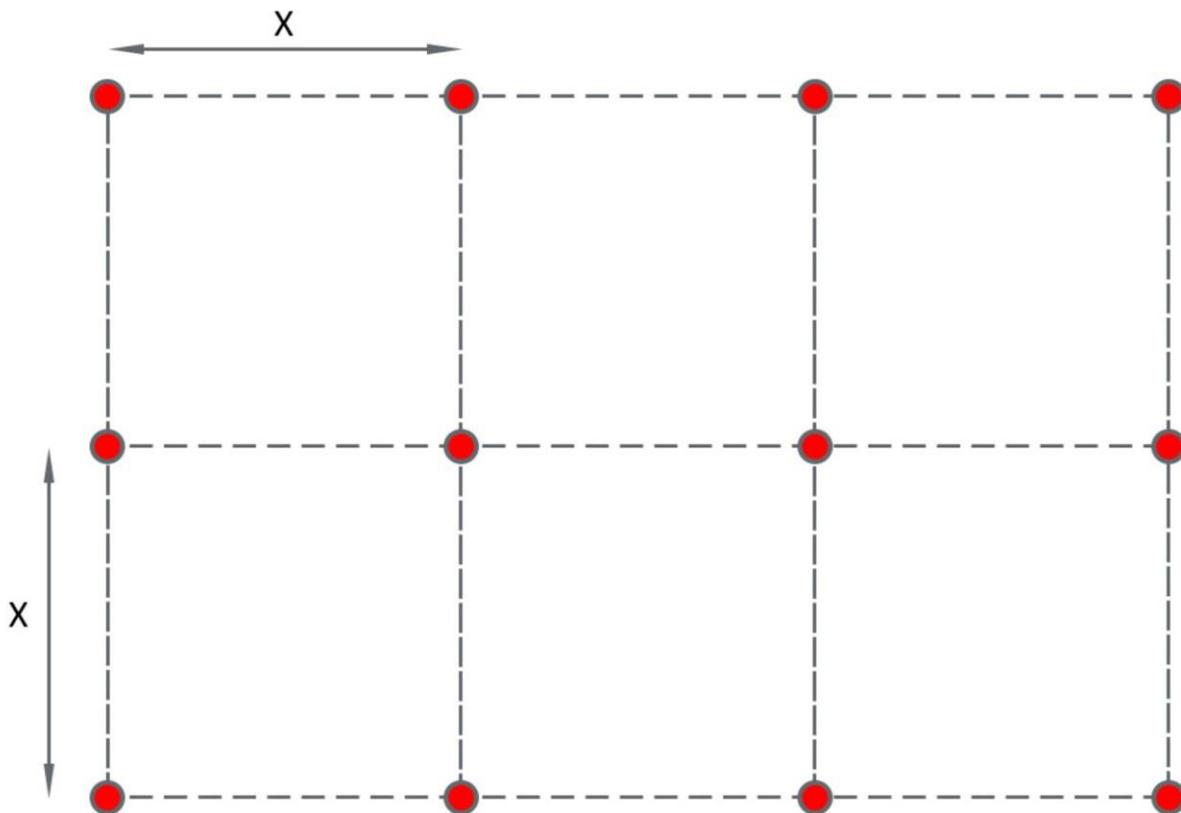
Plan de chevillage complémentaire pour finition par plaquettes en terre cuite
